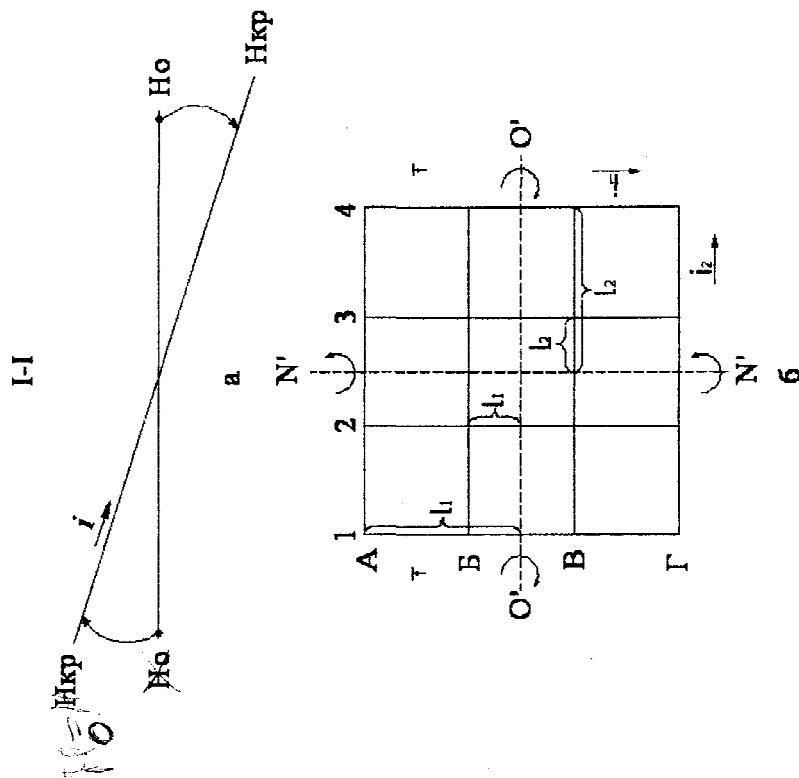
Схема поворота площадки: а – в разрезе; б – в плане
